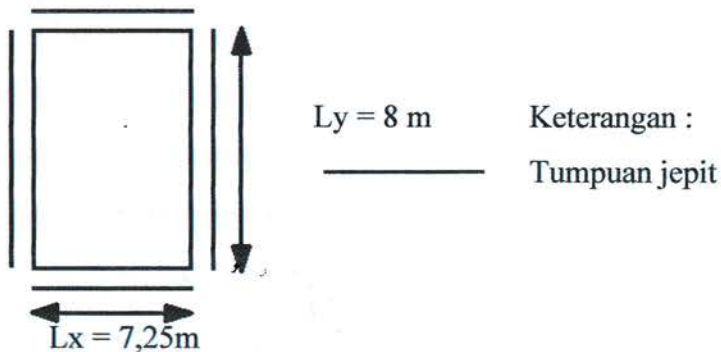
Pembesian Plat Lantai di lantai 2
